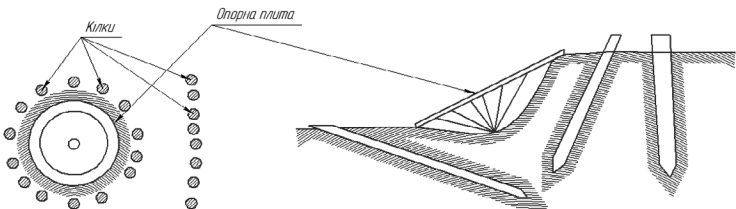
Установлення опорної плити на ґрунті, укріпленого кілками, вбитими похило
